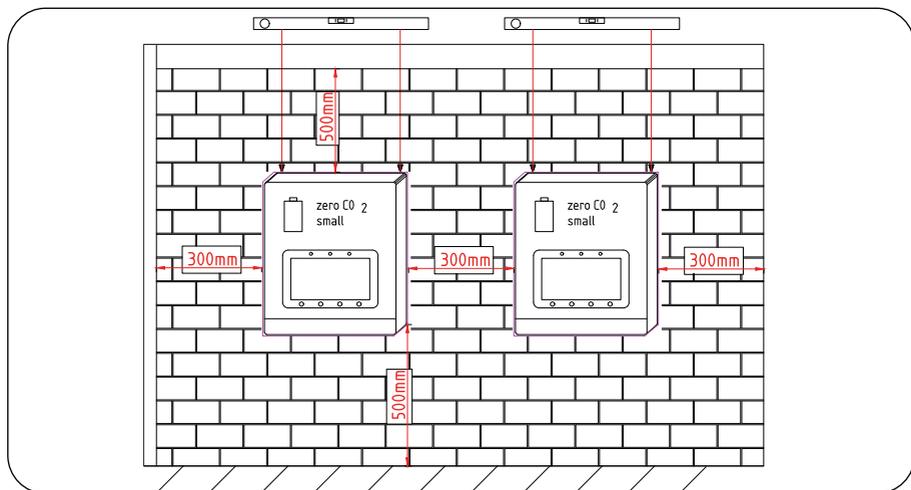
Spazio di installazione dell'inverter (distanze minime), vista frontale
